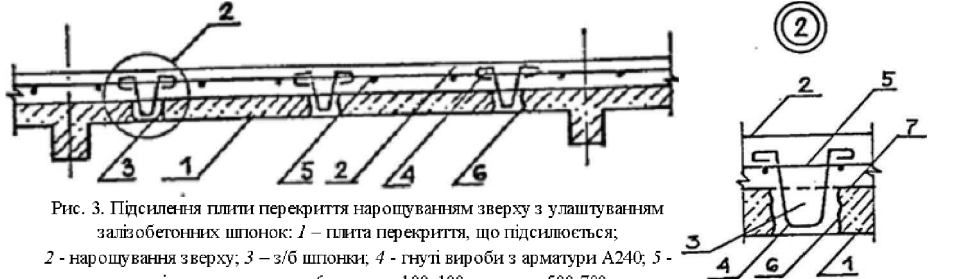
Підсилення плити перекриття нарощуванням зверху з улаштуванням залізобетонних шпонок: 1 – плита перекриття, що підсилюється; 2 – нарощування зверху; 3 – з/б шпонок; 4 – гнуті вироби з арматури А240; 5 – арматурна сітка нарощування; 6 – отвори 100x100 мм через 500-700 мм в шаховому порядку у плиті, що встановлюється; 7 – поверхня плити, що підсилюється, підготовлена до бетонування (очищення і насичка)
